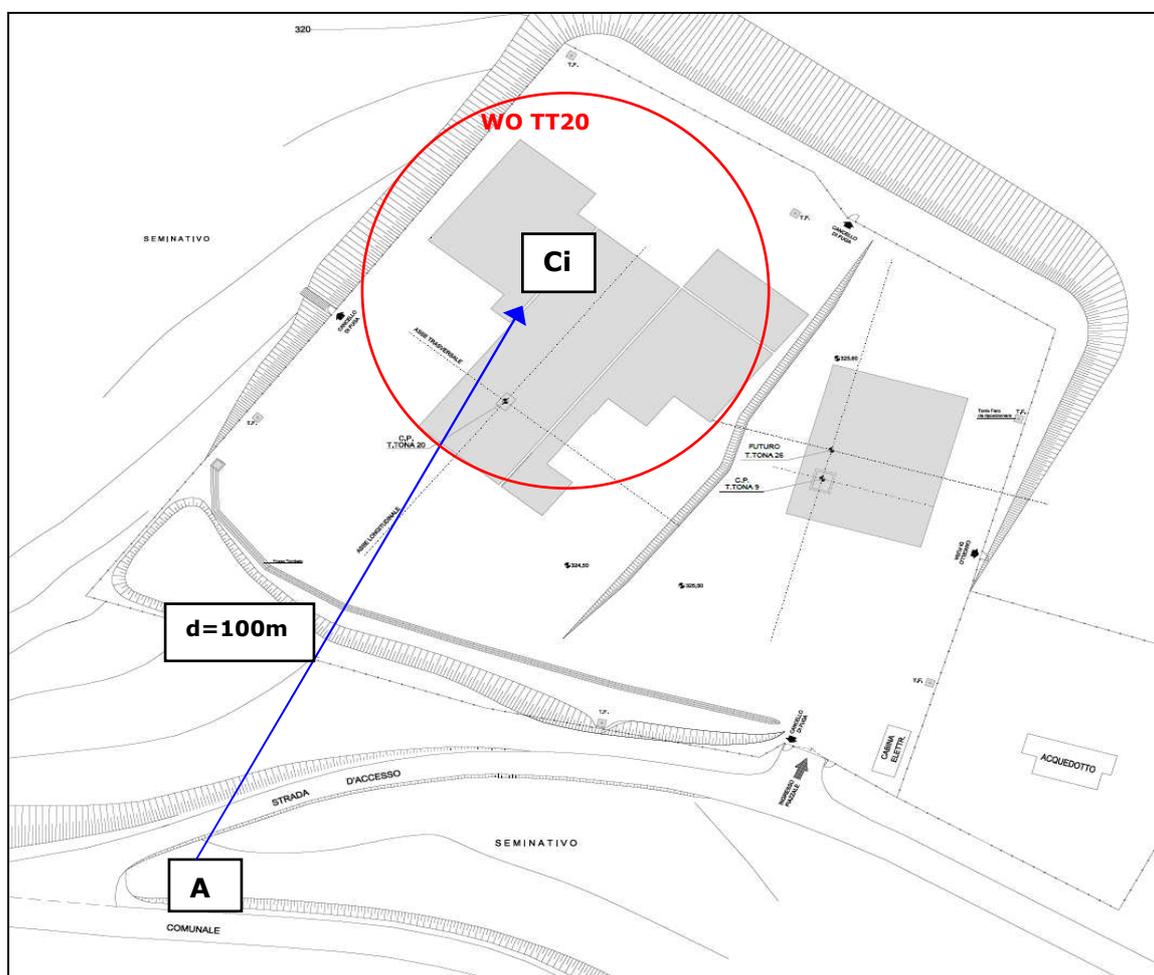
Planimetria stato di fatto con individuazione dell' area di Workover sul TT20.
